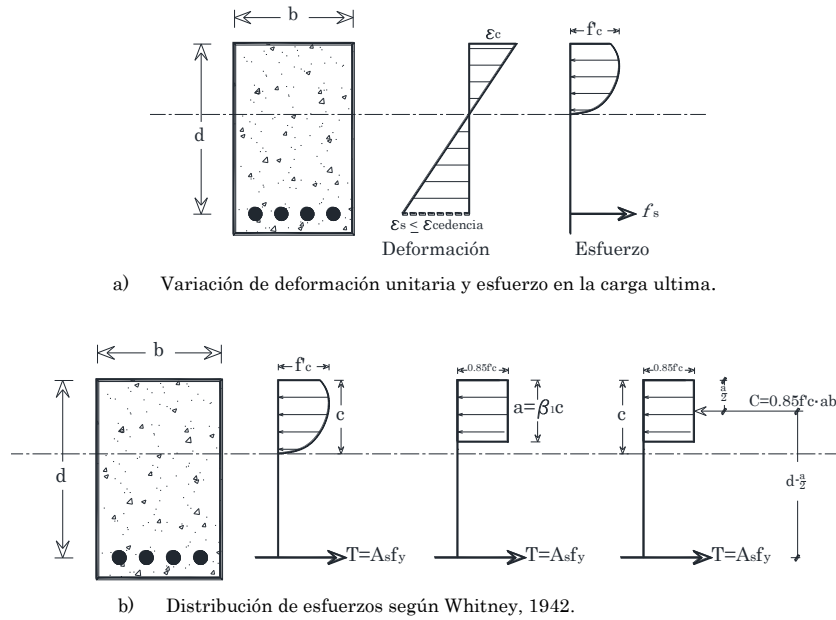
Deformación unitaria y esfuerzos en una viga de concreto reforzado.
